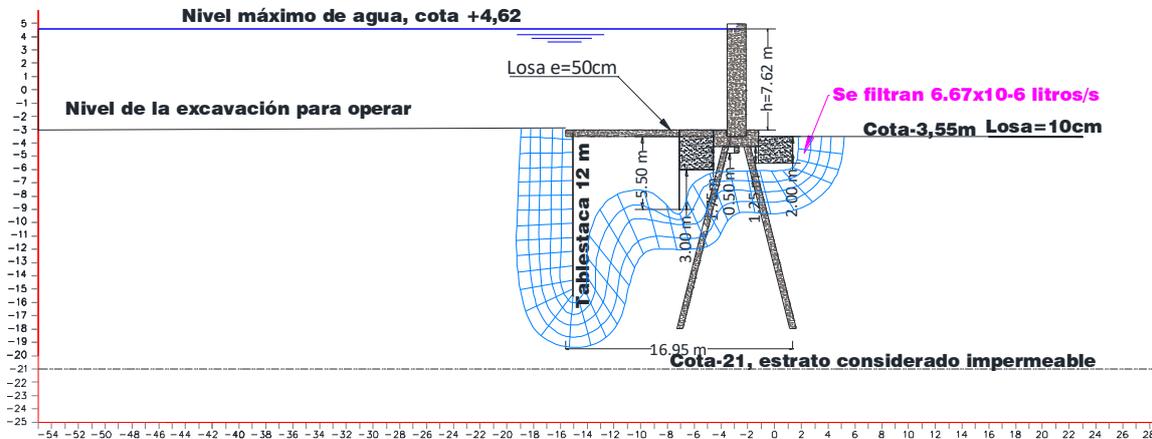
Solución dejando también las tablestacas de 6m, hincadas para excavar en la cimentación.
